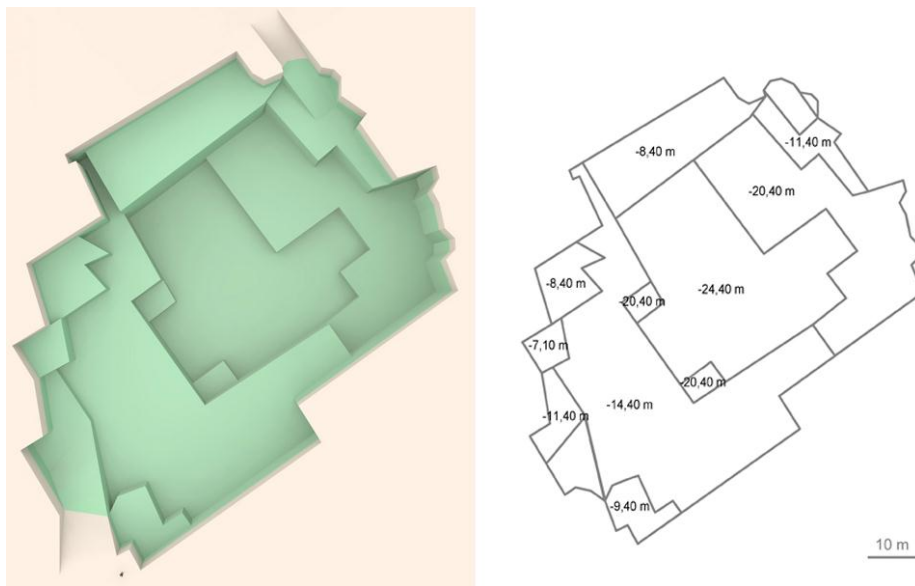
Modello tridimensionale, vista dall'alto e planimetria quotata
